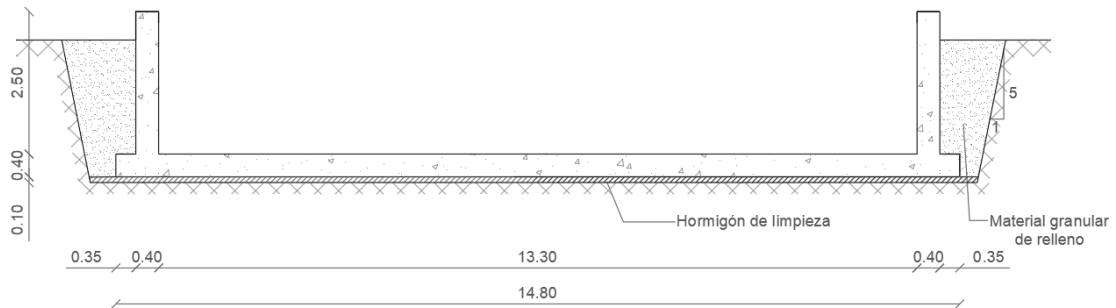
Sección propuesta para el tramo IIIb del encauzamiento. FUENTE: Elaboración propia
